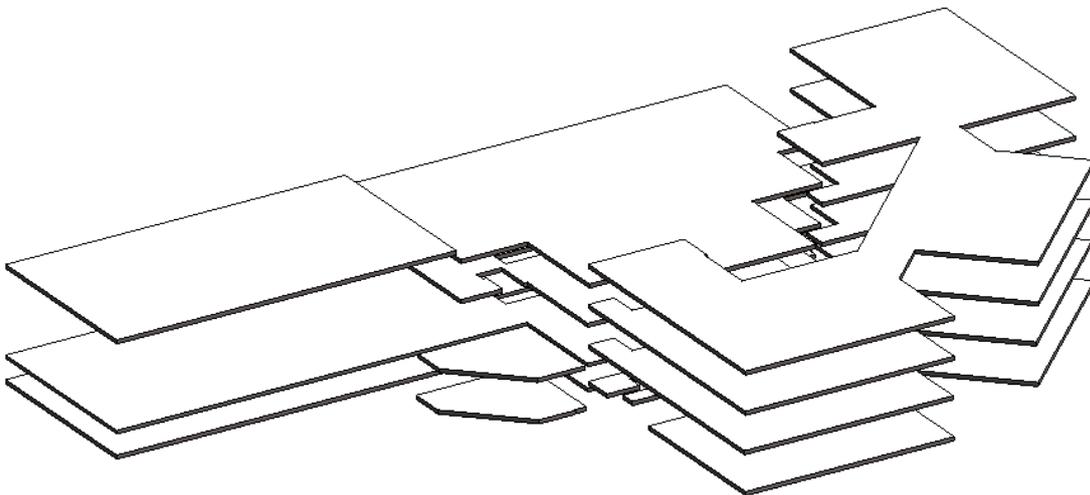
Vista assonometrica dei solai (Fuente propio)
